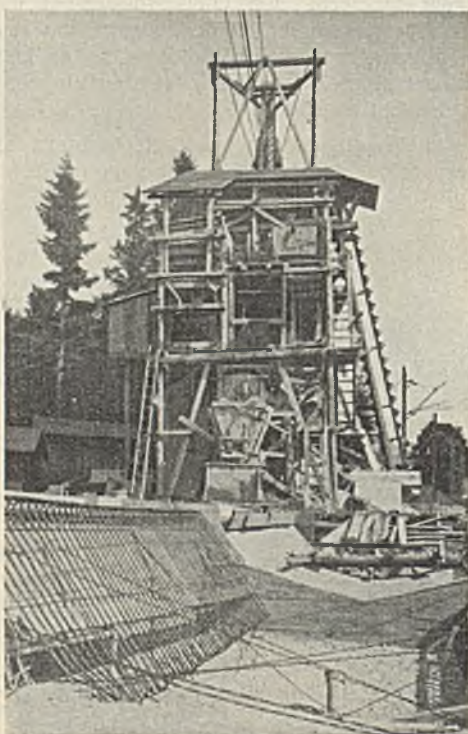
Salzburger Turm des Kabelkranes mit Betonbereitungsanlage.
